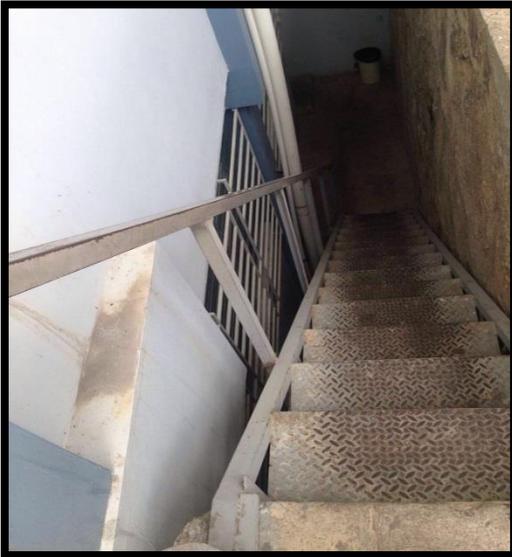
Estrechez de las escaleras que se dirigen al almacén, dicha característica dificulta el traslado y movilización de los trabajadores
